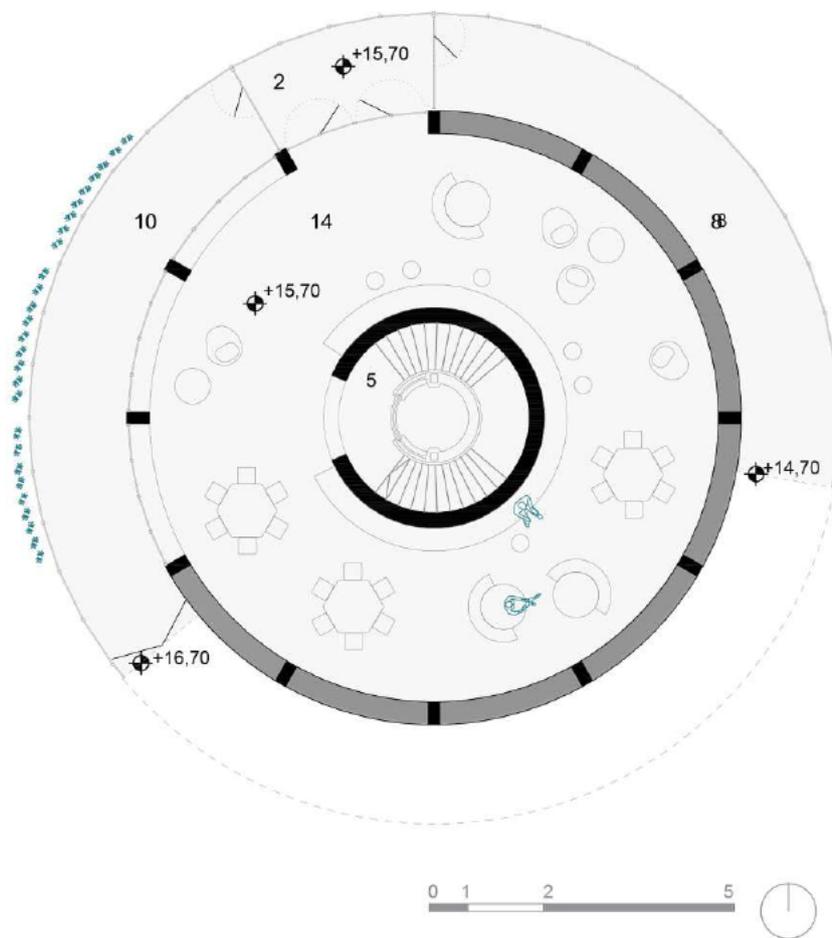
Grundriss 2.Obergeschoss
